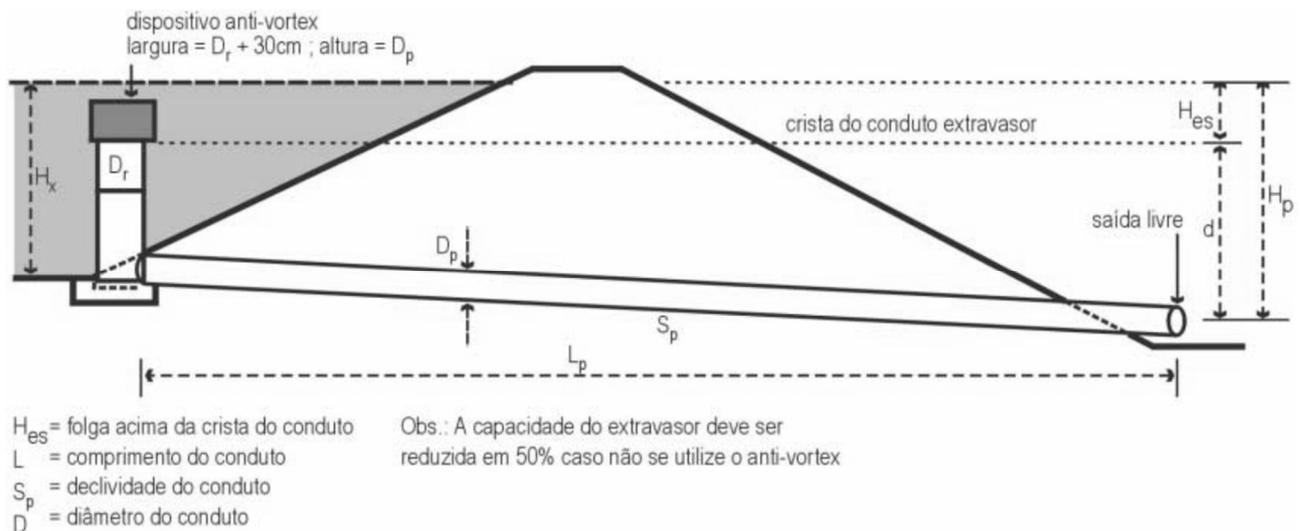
Orifício e conduto (FONTE: SUDERHSA [6])
